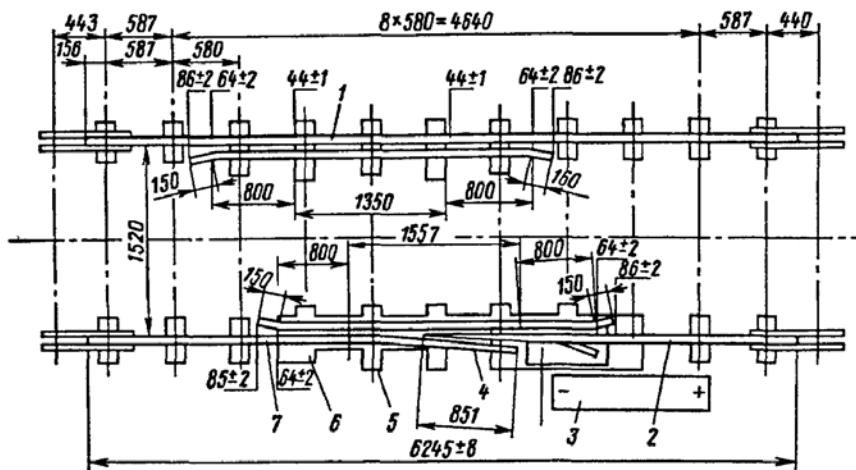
Уравнительный прибор-башмакосбрасыватель в подгорочных путях: 1 — путьевой рельс с контрольным; 2 — задний вылет башмакосбрасывателя; 3 — металлический лист, защищающий брус от падающего башмака; 4 — усовик — подвижная часть уравнительного прибора-башмакосбрасывателя; 5, 6 — сквозные подкладки, 7 — передний вылет башмакосбрасывателя
